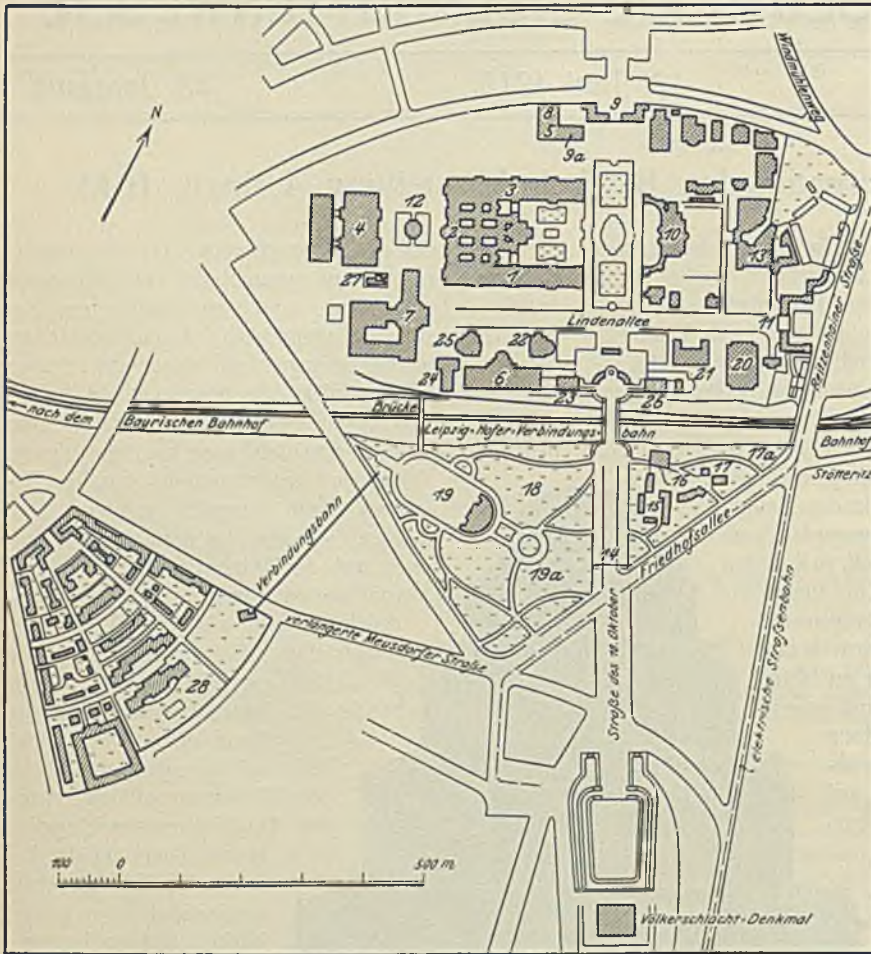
Lageplan der Baufach-Ausstellung, Leipzig 1913.
